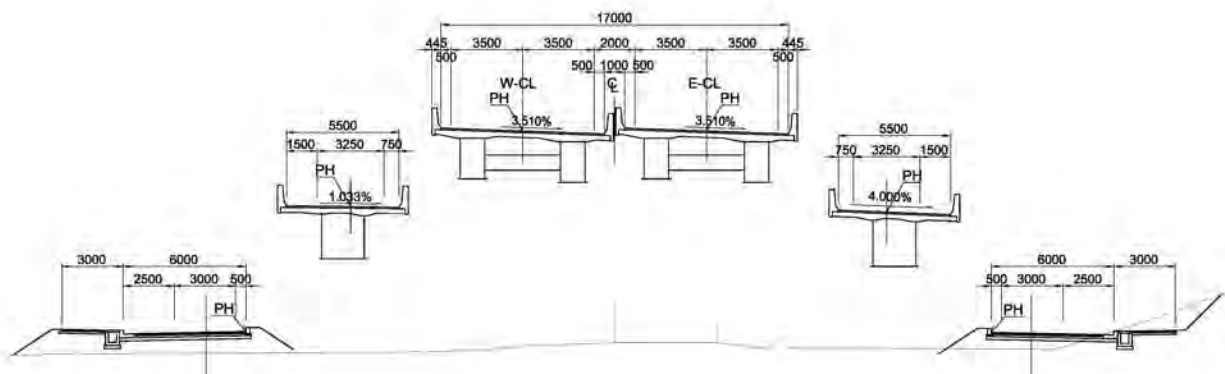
(3) 橋梁部 ON-OFF ランプ区間標準横断面図
